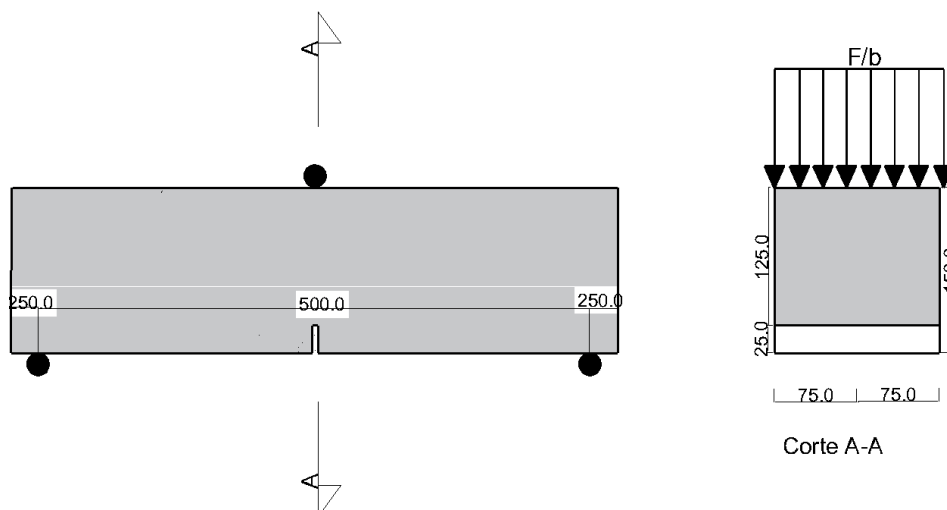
Esquema de um ensaio de flexão a 3 pontos com entalhe. Medidas em mm.
